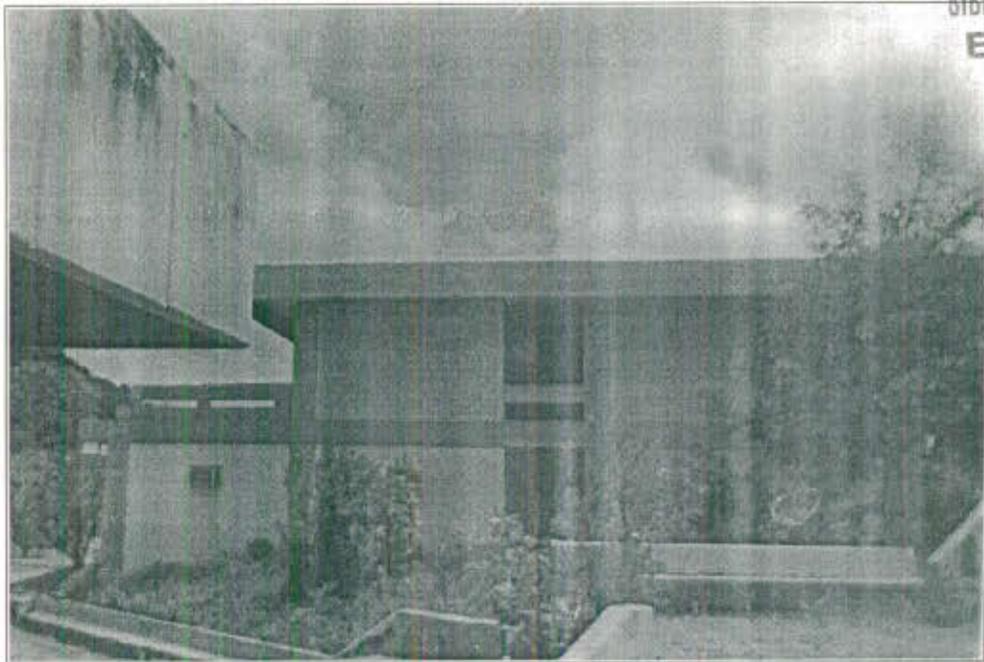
VISTA DE PLANTA BAJA DE EDIFICIO DE AULAS DE F.I.M.C.M.
